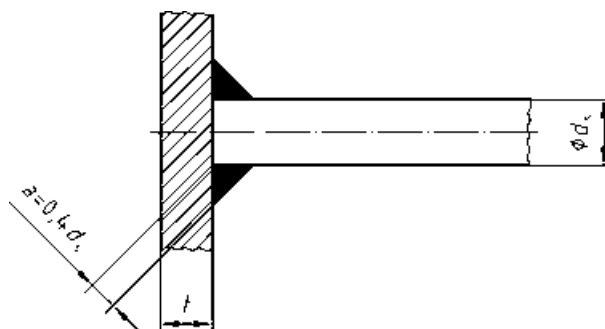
Stirnkehlnaht am durchgeführten Stab
